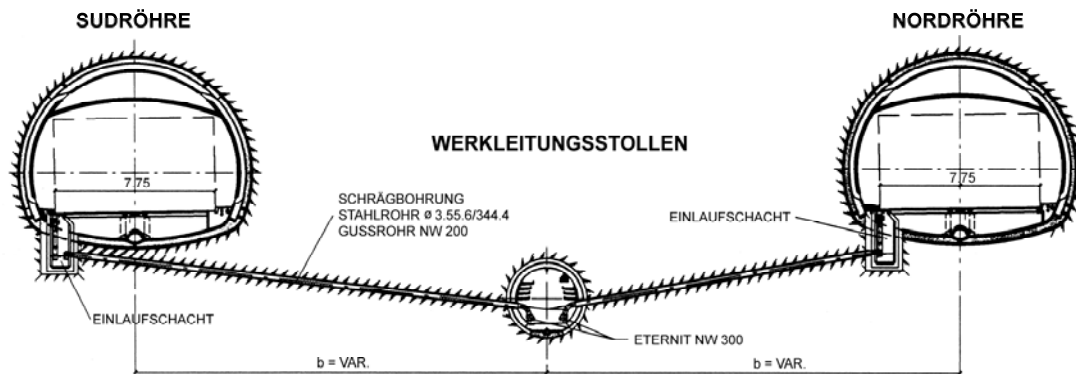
Schrägbohrungen vom Werkleitungsstollen zum Einlaufschacht
